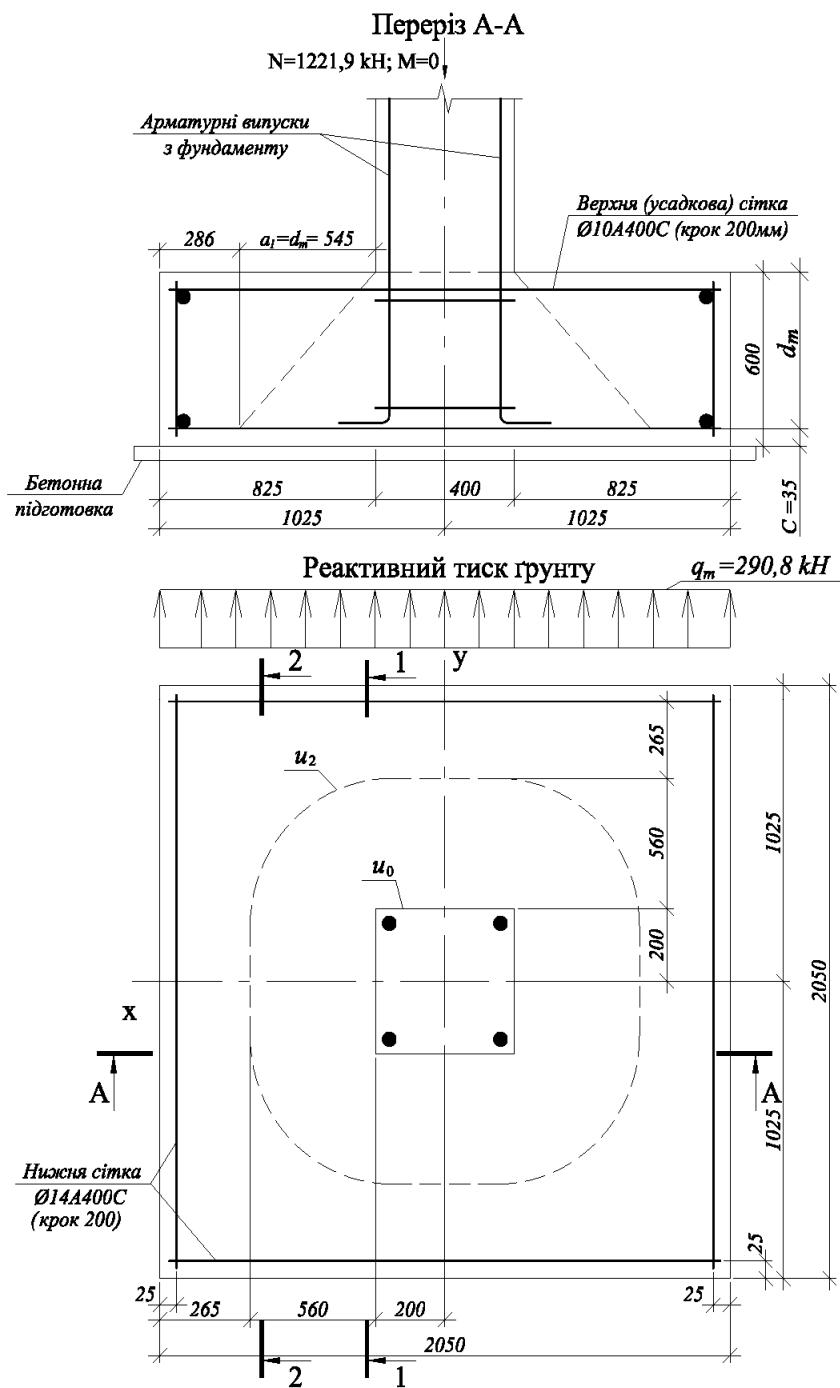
Конструктивна схема плоского (плитного) фундаменту
